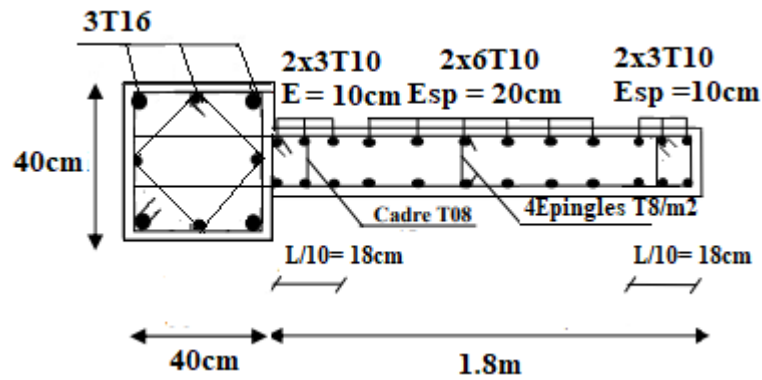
Dessin de ferrailage du voile V'2 du RDC-1<sup>er</sup> étage
